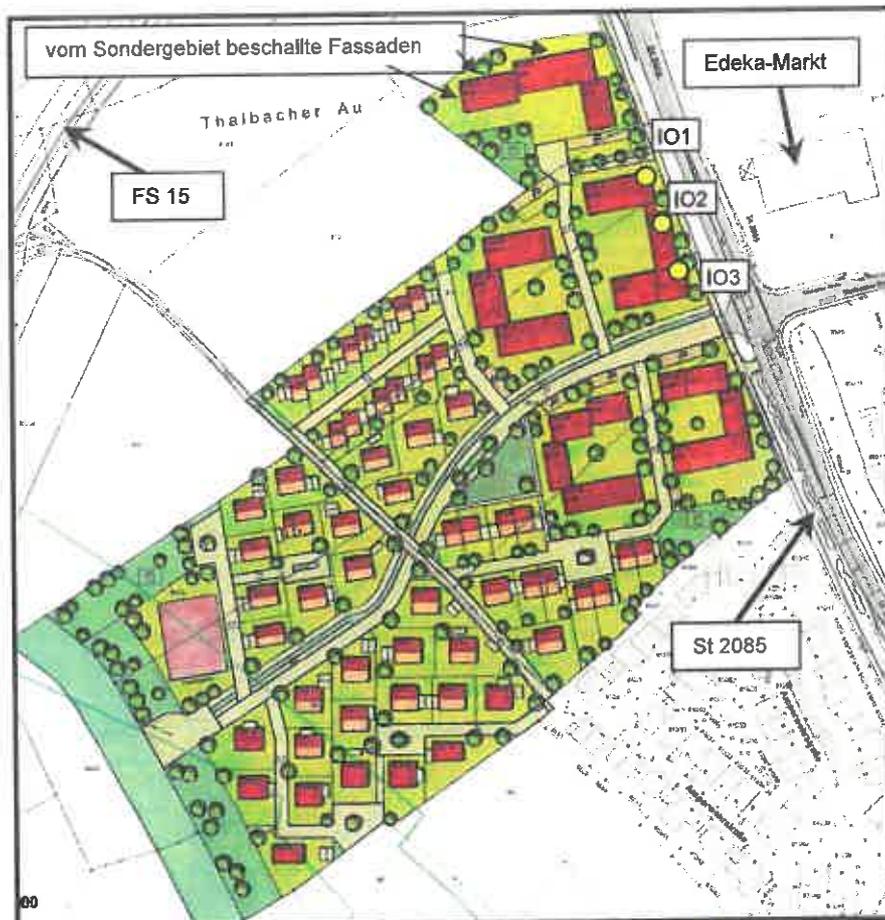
Vorentwurf Bebauungsplan "Amperauen" (WA) ● Immissionsorte
